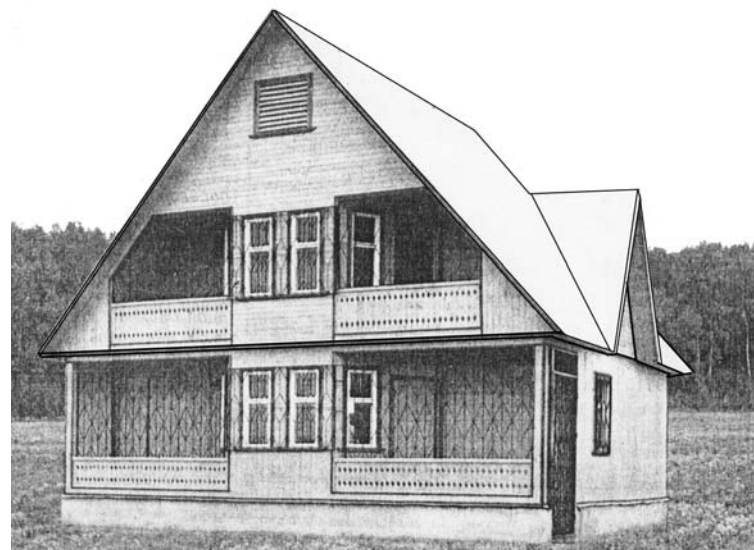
Общий вид сельского жилого дома коттеджного типа
